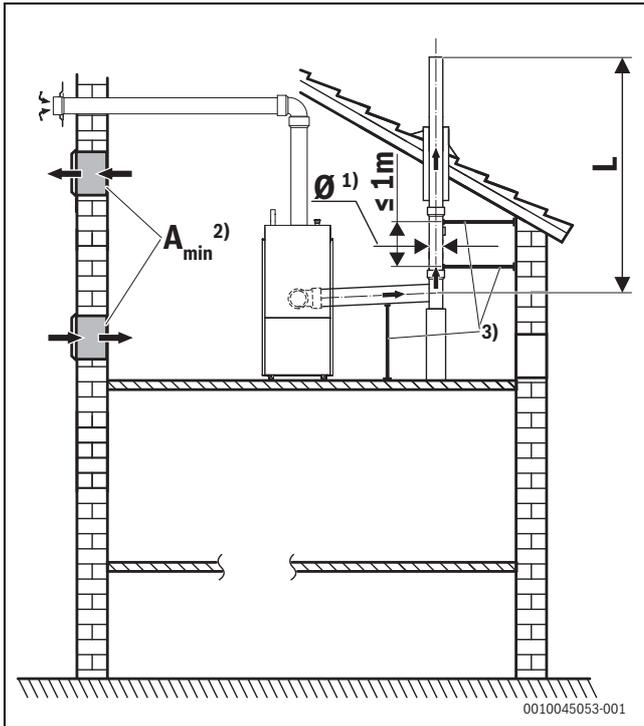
Hauteur effective de la conduite d'évacuation des fumées, sans conduit, centrale sous toit, variante 3
